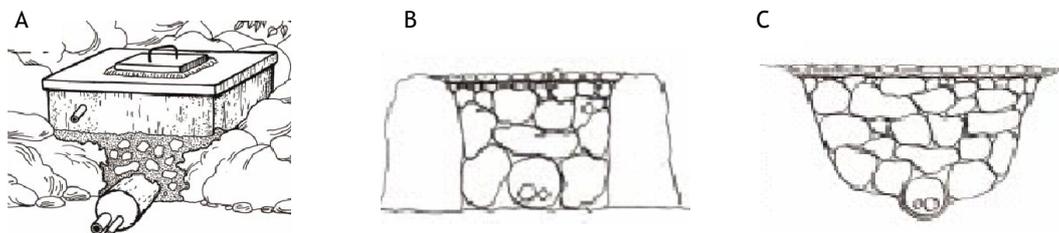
A. Estructura de protección con caja de cemento para fuentes definidas. B Estructura de protección para fuentes poco definidas ubicadas sobre superficie rocosa. C. Estructura con relleno de piedras para zanjonés. Fuente: CEPIS (2005)
